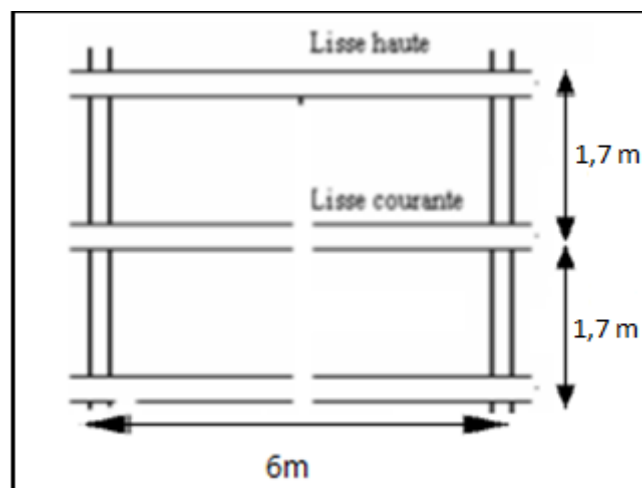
Coupe longitudinale sur les lisses de bardage.
